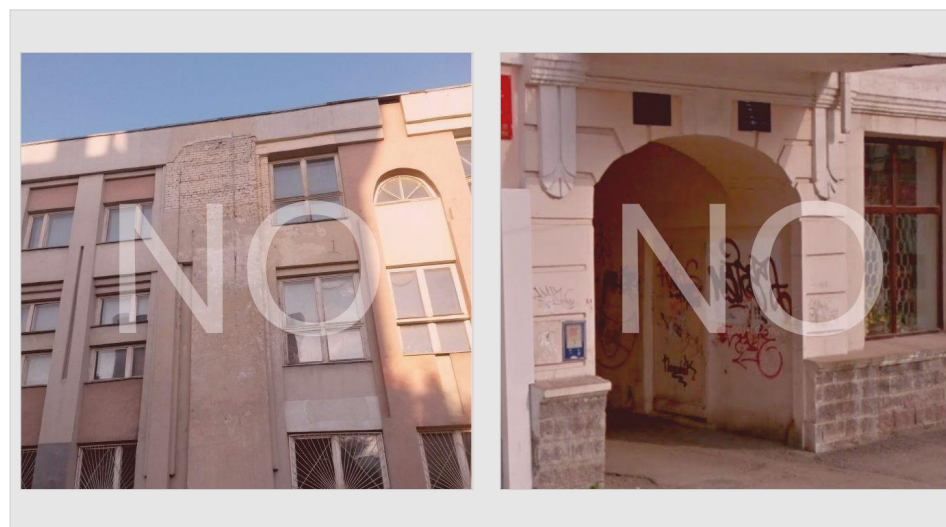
Фасады зданий частично разрушены или загрязнены
